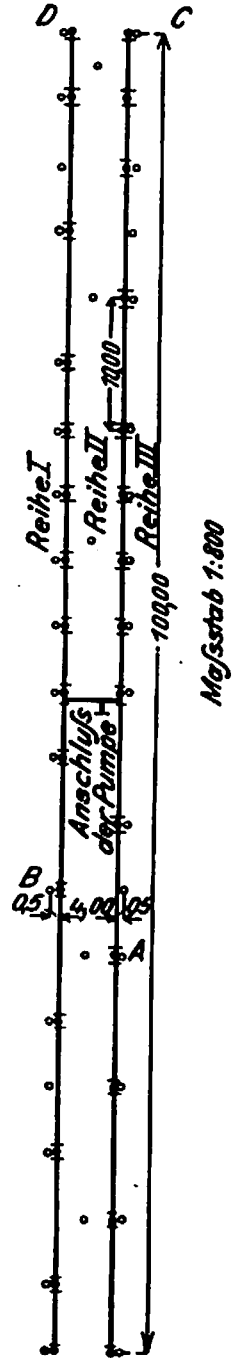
Lage der Brunnen und Beobachtungsröhre. Wasserwerk Müggelsee. Versuchsbrunnenanlage zur Absenkung des Grundwasserspiegels mit Hilfe eines zweireihigen Systems von Hilfsbrunnen.
